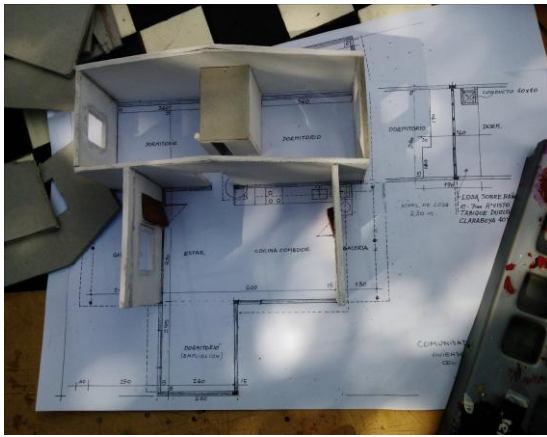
y 10 Una de la viviendas propuesta y asamblea para aprobar los proyectos de viviendas
